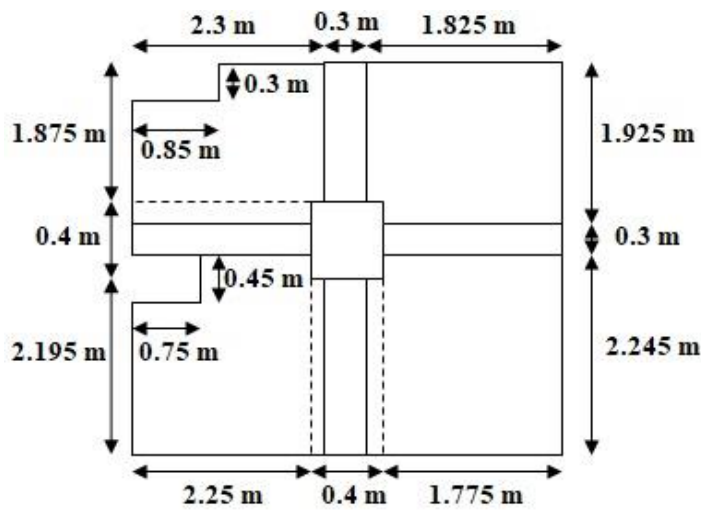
Dimension du poteau centrale (RDC et 1er étage).
